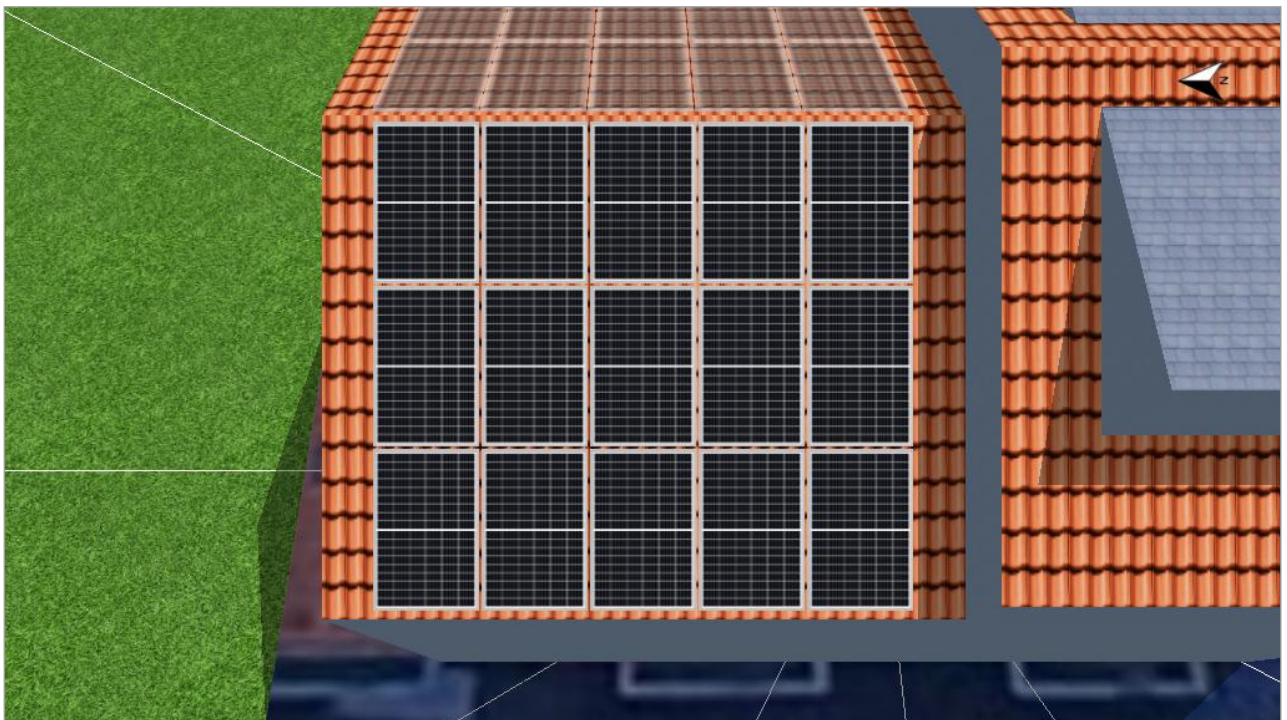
Modulfläche - Gebäude 02-Dachfläche West
